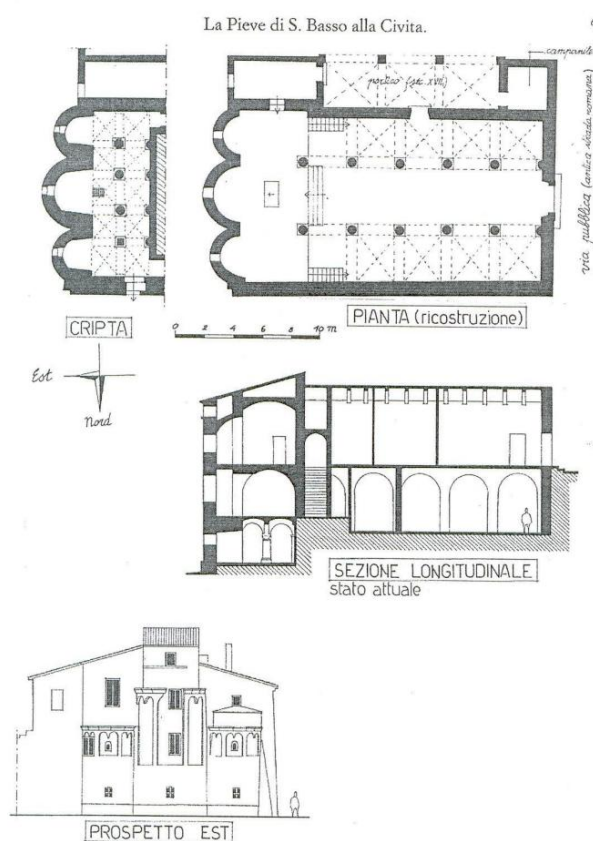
Pianta e prospetto della pieve di S. Basso alla Mensula (da Marozzi 2004, p. 84, fig. 36).
